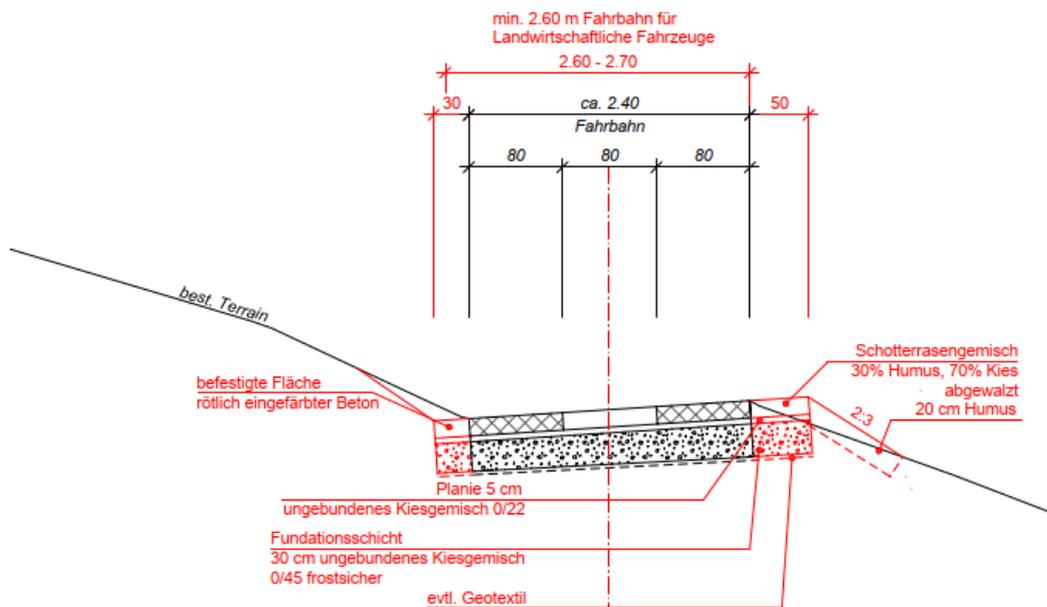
Normalprofil auf Bestand (mit bereits eingebauten Roli-Elementen)
